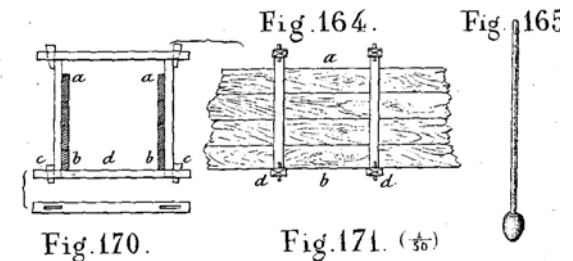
Esquema de los elementos de un muro de tapia extraído del tratado de Rebolledo, 1875.
